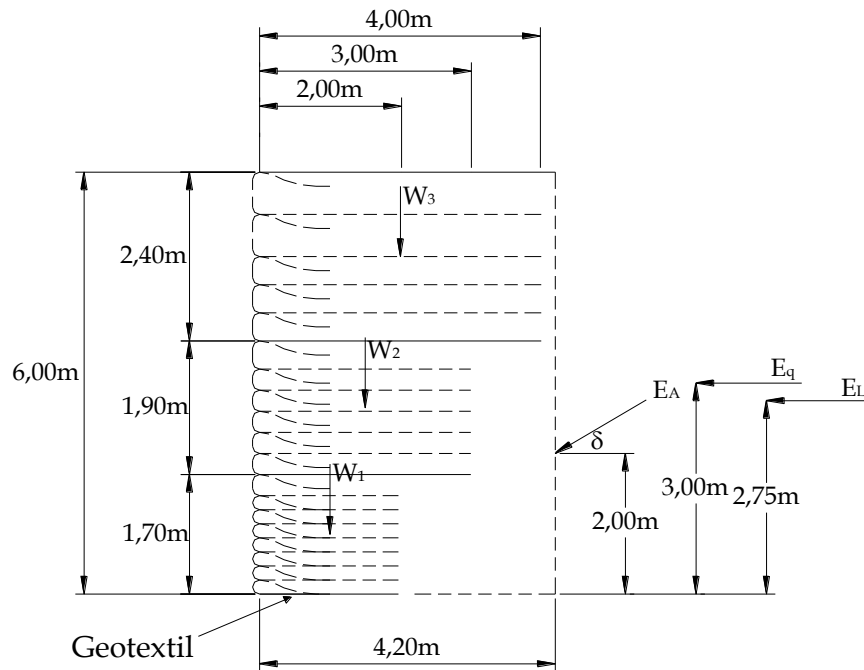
Fuerzas que actúan en un muro reforzado con geotextiles.
